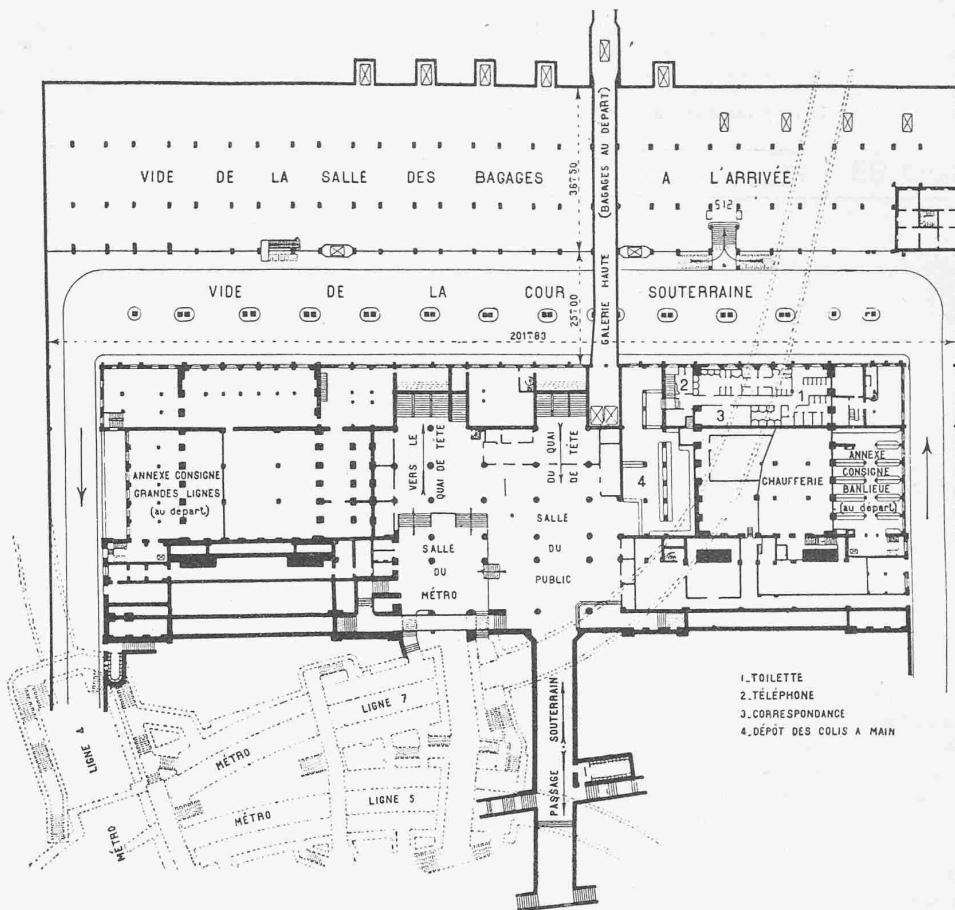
Erstes Untergeschoss, mit Anschluss an Métro und die Trottoirs der Rue de Strasbourg.
